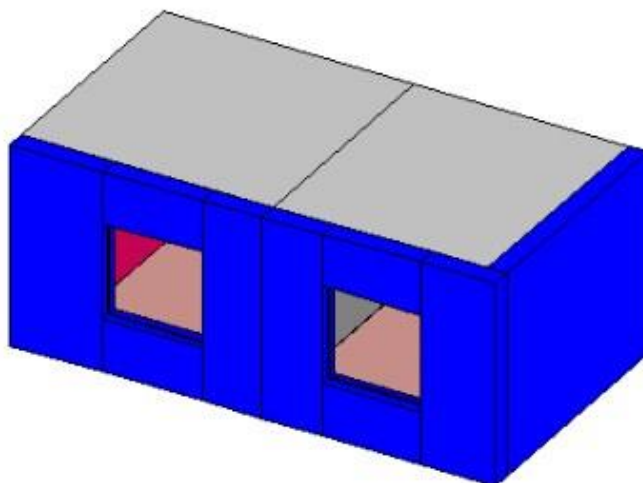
Configuration Acoubat pour la façade à double contreventement.
